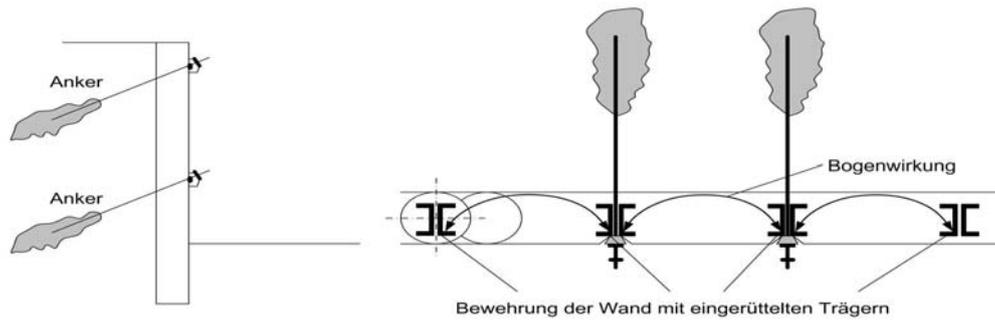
Bewehrung der Mix-in-Place-Wand mit eingerüttelten Trägern
